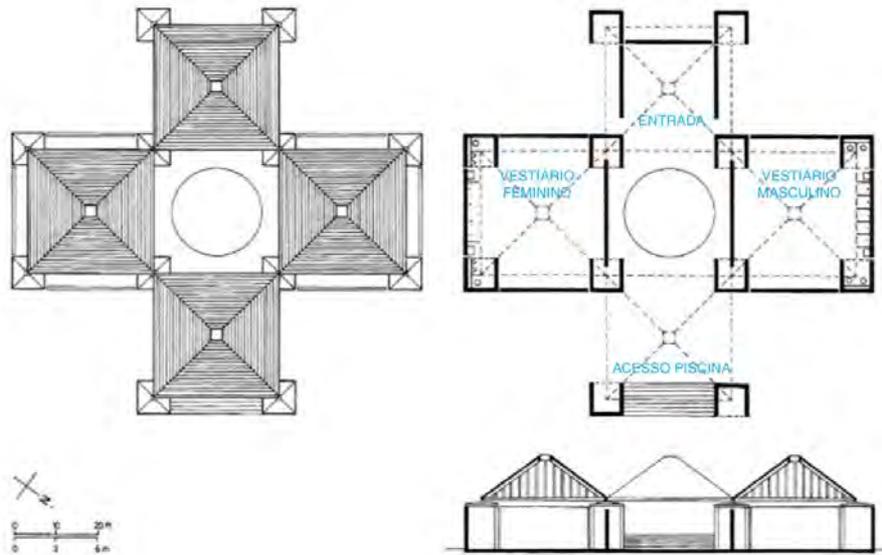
| Planta baixa e corte da Casa de Banho [greatbuildings.com]
